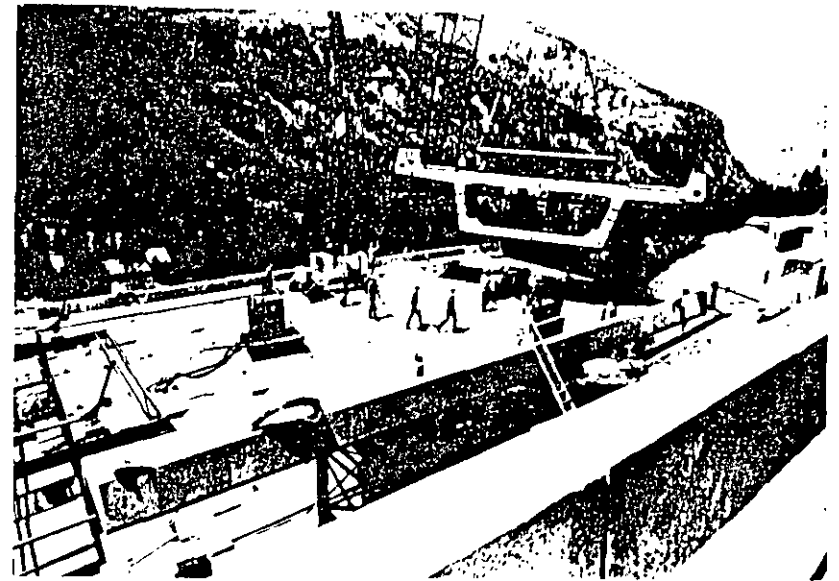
Construcción del tablero preesforzado de un puente mediante el ensamble de miembros huecos prefabricados. En las paredes de la viga cajón se dejan lengüetas y ranuras que sirven para alinear cada miembro con el instalado previamente.
